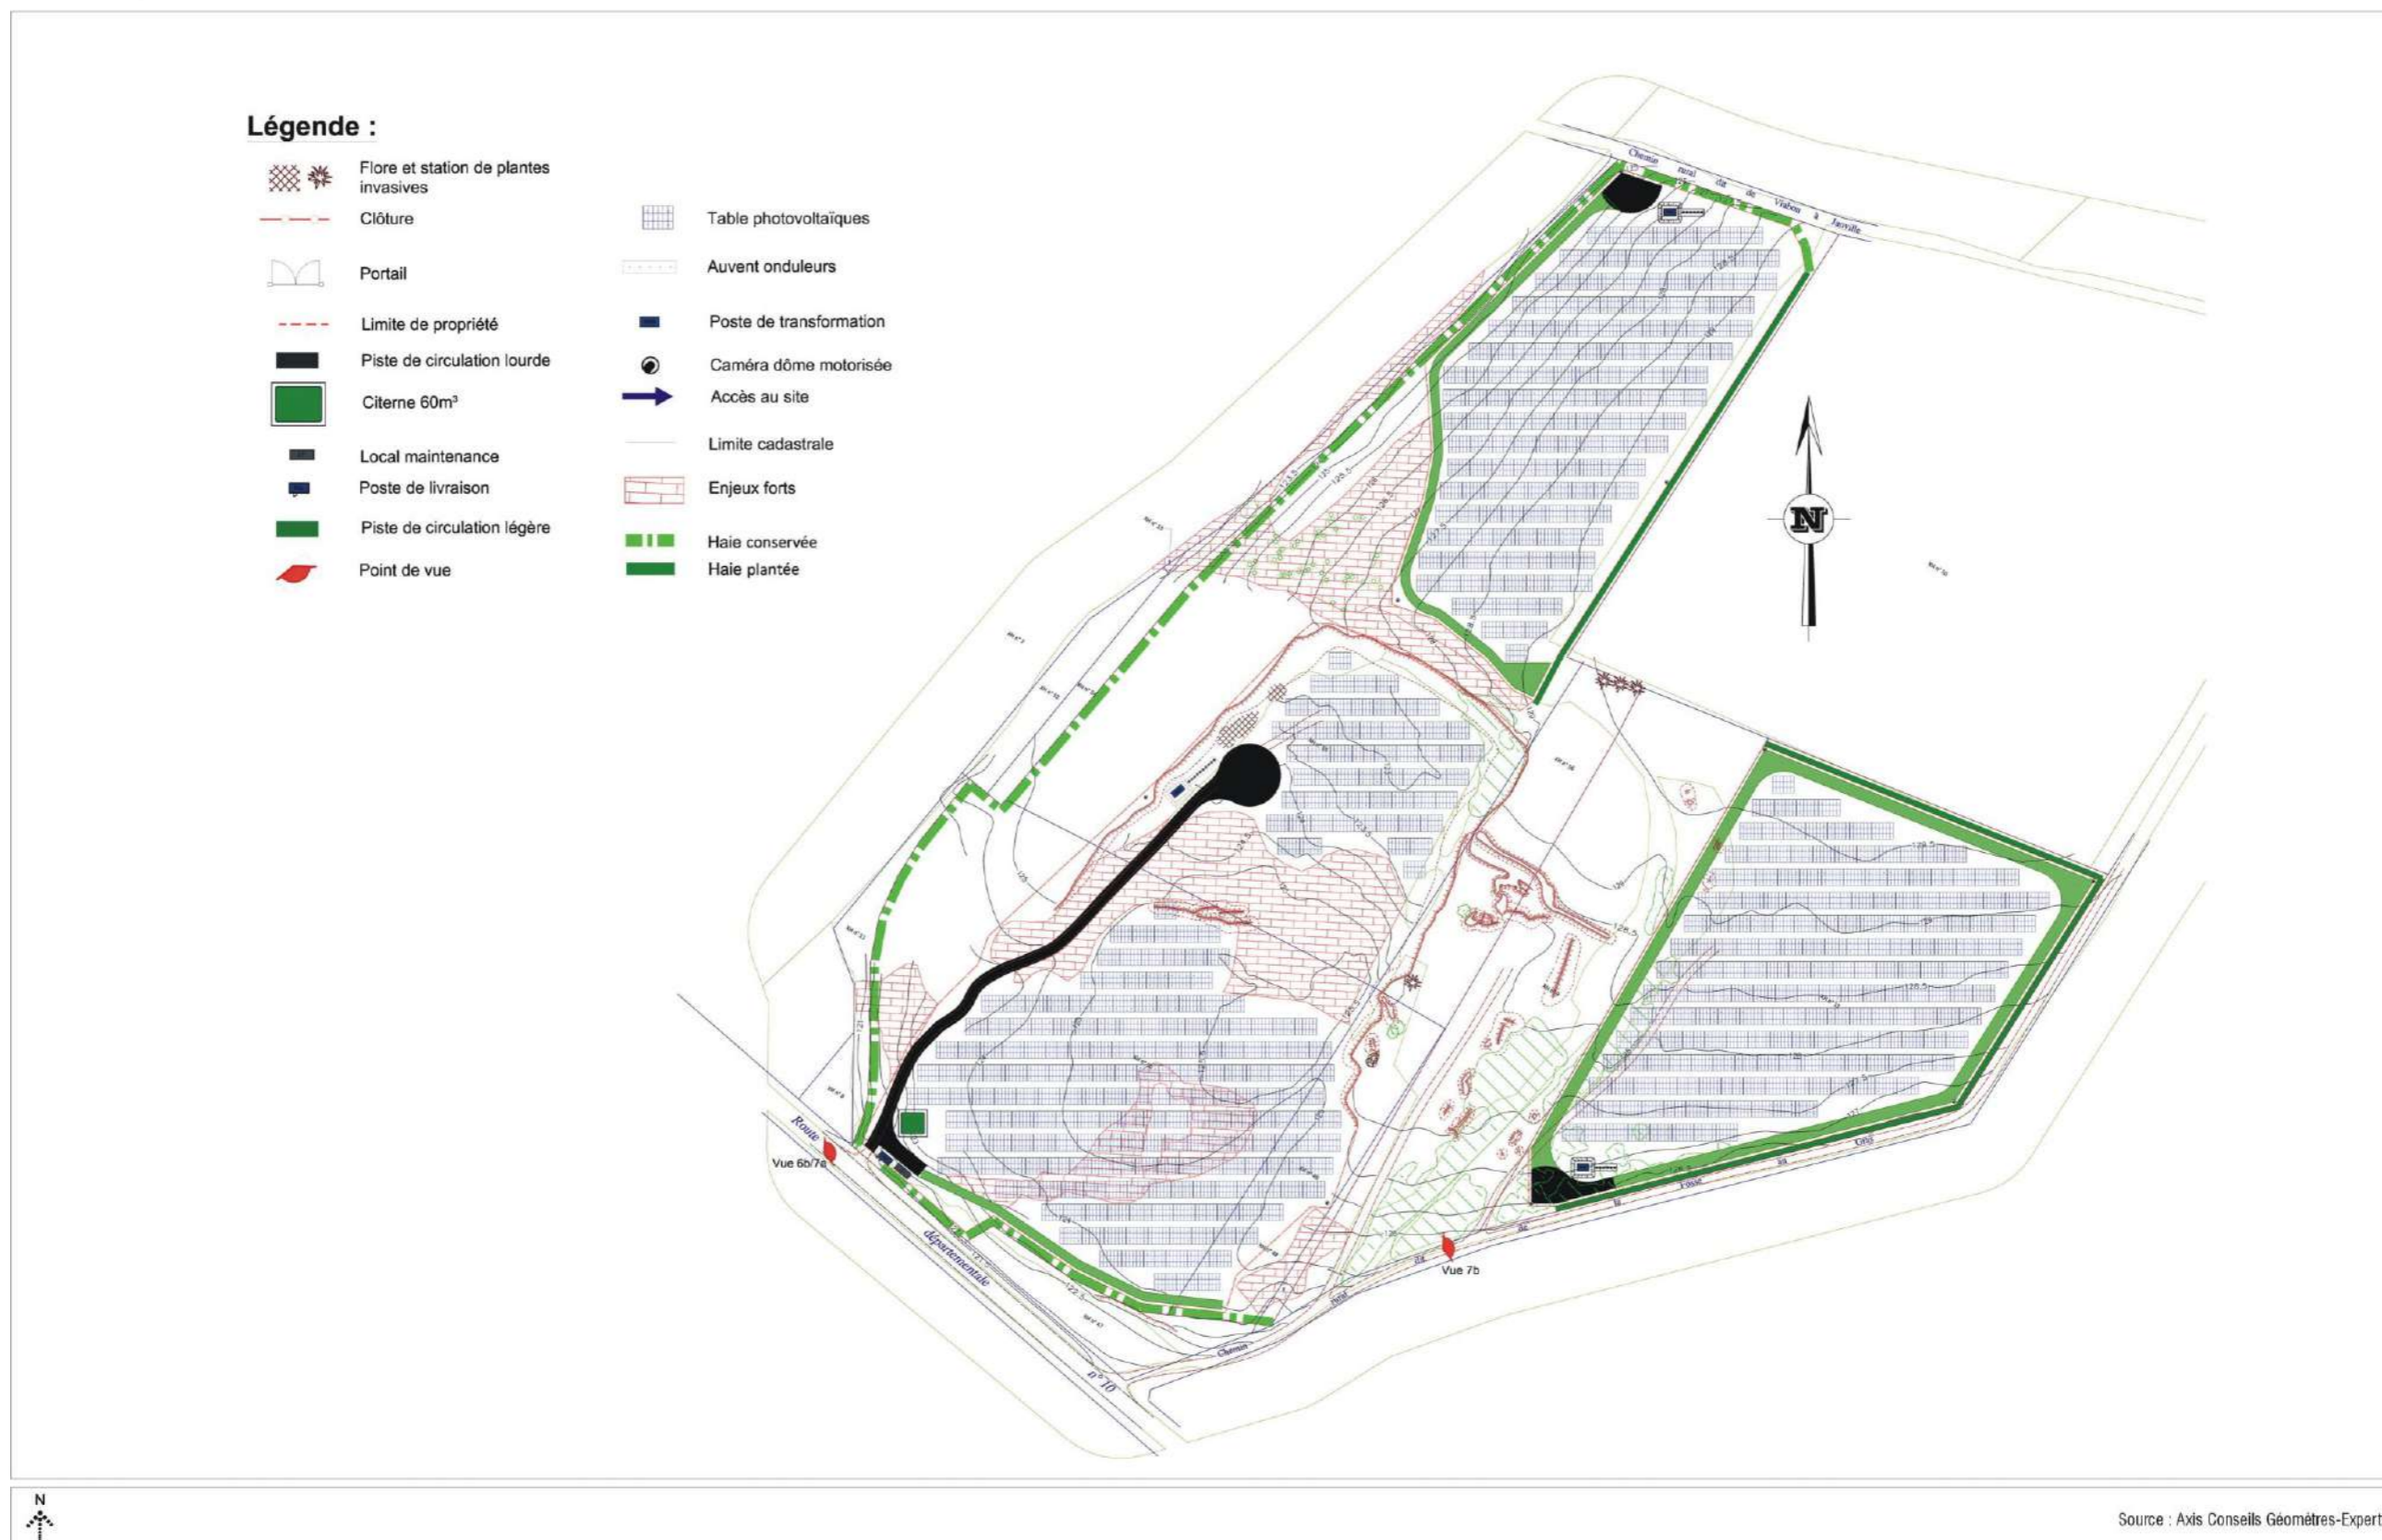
Parc photovoltaïque au sol d'Eole-en-Beauce - Plan masse
